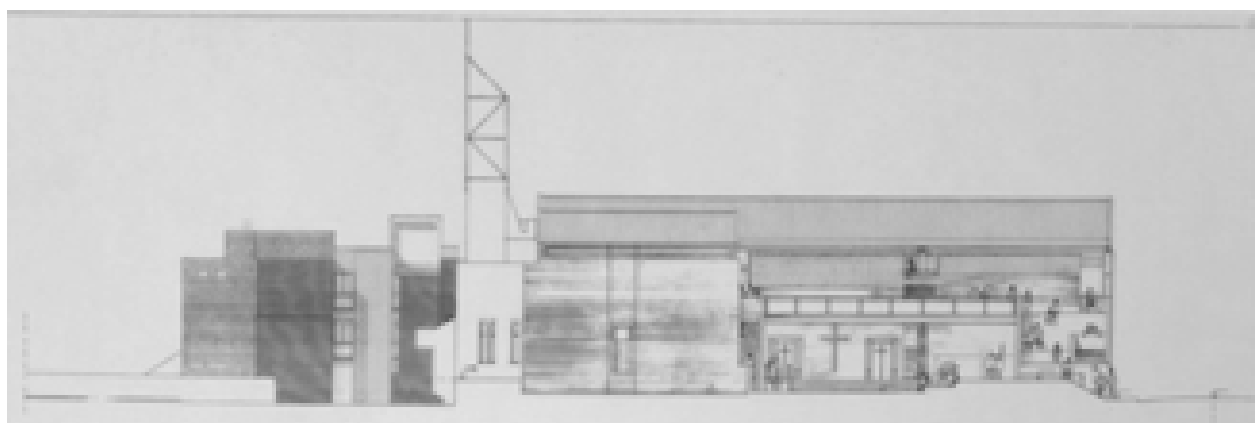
Prospetto Est, stato concessionato –10/09/2007 (AABS-1996.48)
